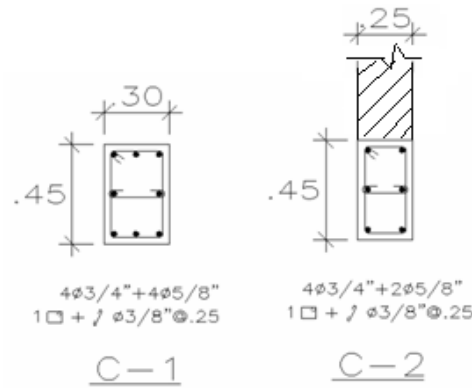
Detalle de columnas de concreto reforzado (colegio 780 antiguo).
